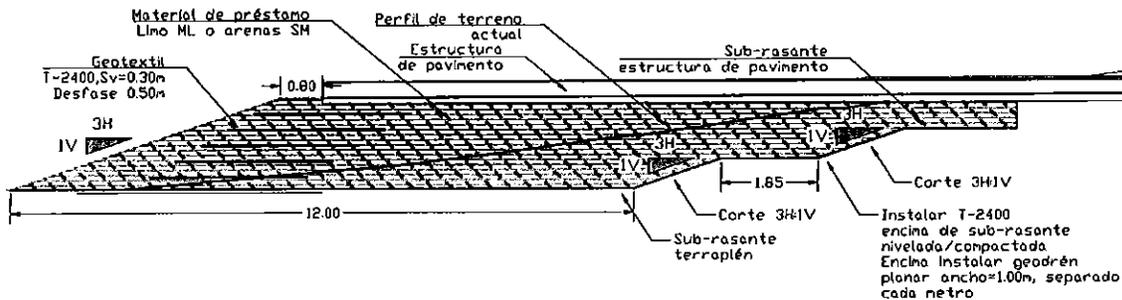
Detalle de corte, preparación de sub-rasante y reforzamiento con geosintéticos T-2400
